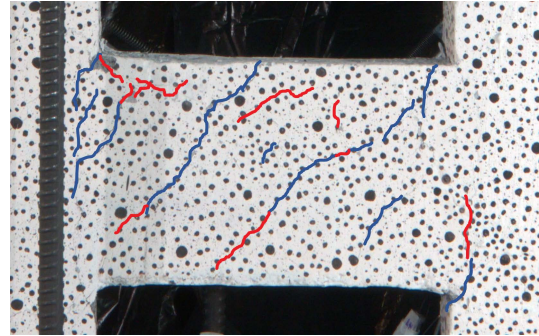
Grietas Vigas a -0.9% Drift
